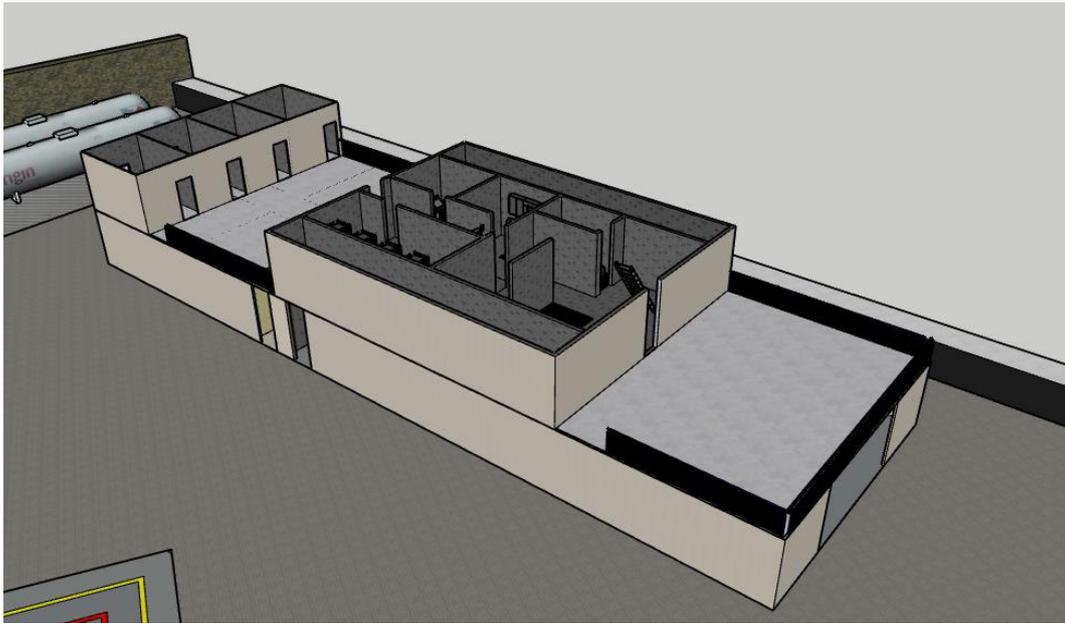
Planta primera de adiestrador de fuegos interiores modelada en SketchUp
